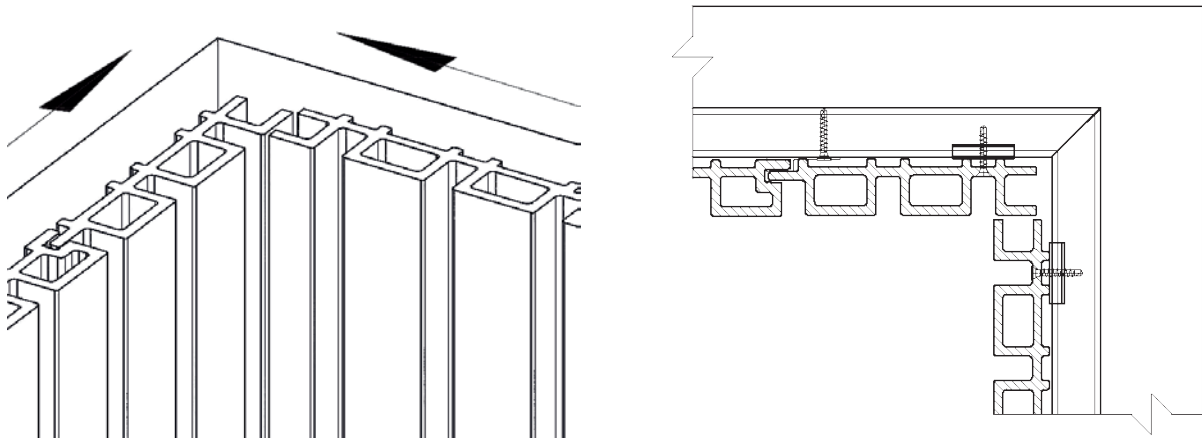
Montaje de la fachada en la esquina interior del edificio
